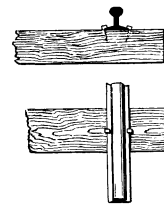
Schienenbefestigung auf hölzernen Schwellen.
